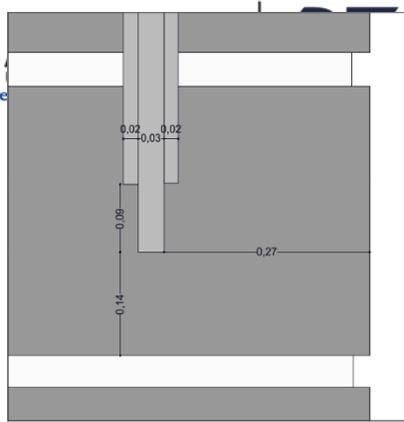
Detalle 10, detalle riel, Estación del ferrocarril Sur.
